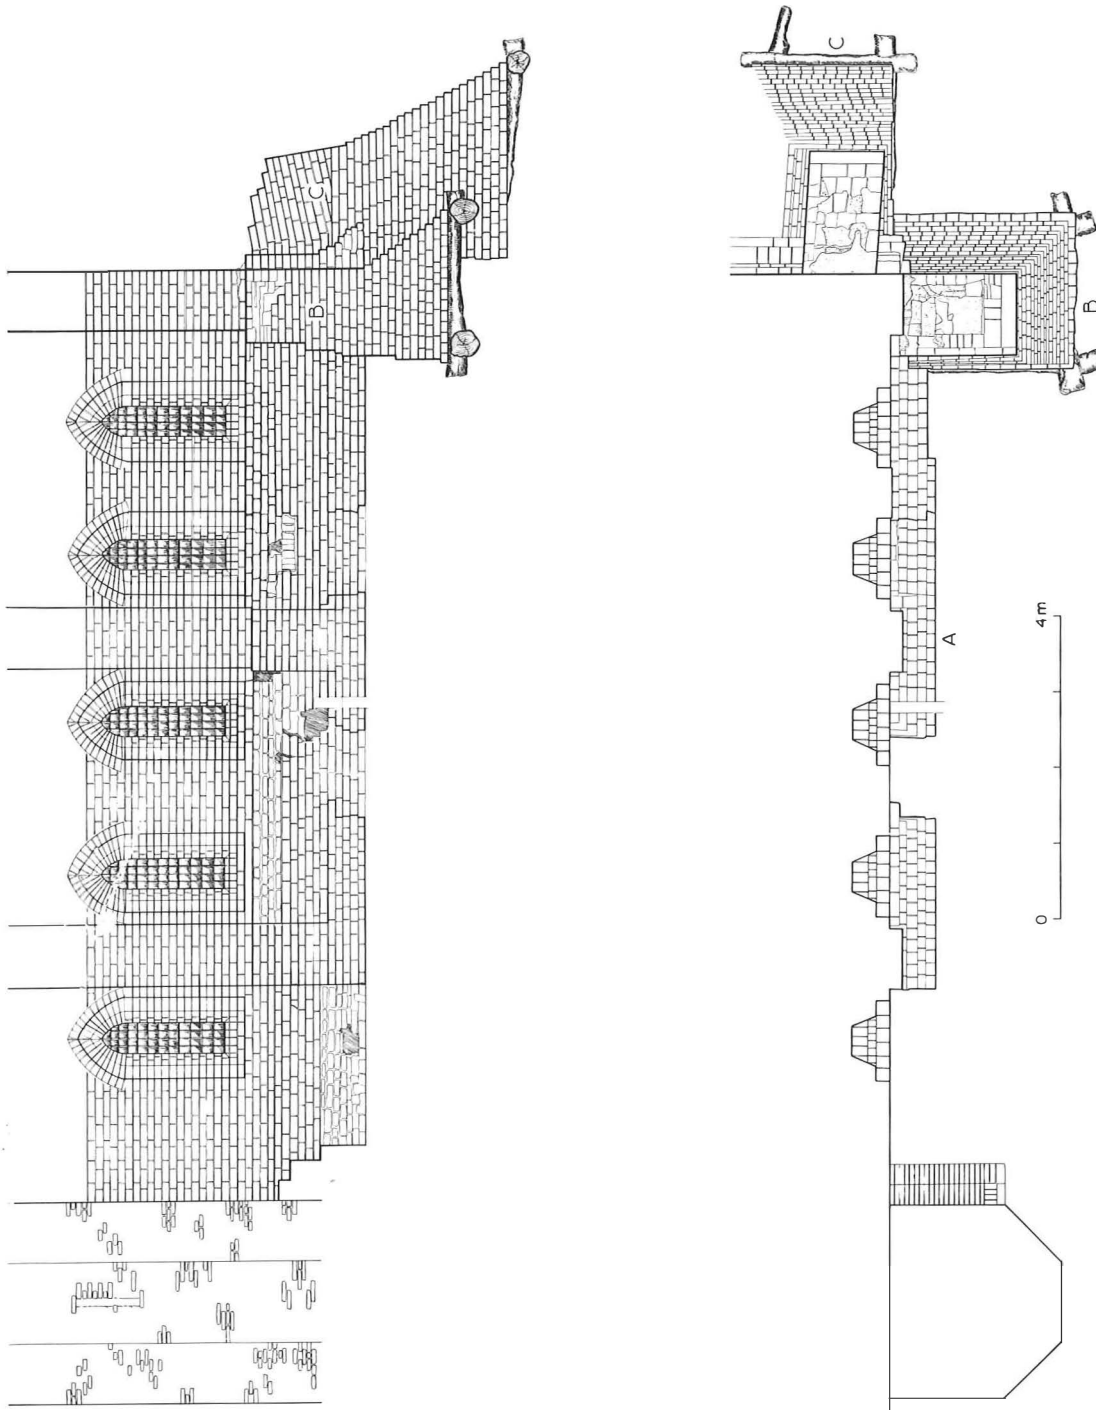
St. Bernardusabtei Aduard. Reformierte Kirche. Westlicher Teil der Nordwand. Ansicht und Grundriss. Zeichnung BAI (R. Woudstra).
